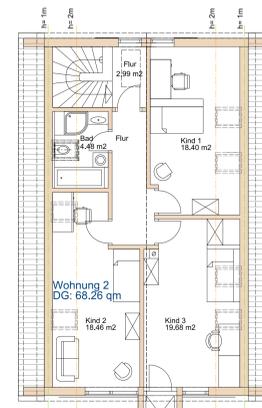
Grundriss Obergeschoss (Neubau)
